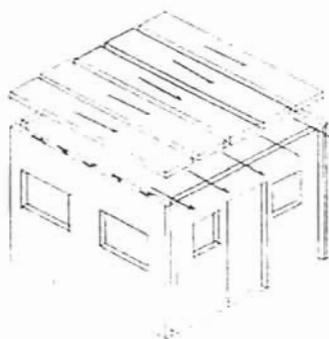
Empujes normales al plano de los muros que se generan cuando la losa no constituye diafragma rígido
